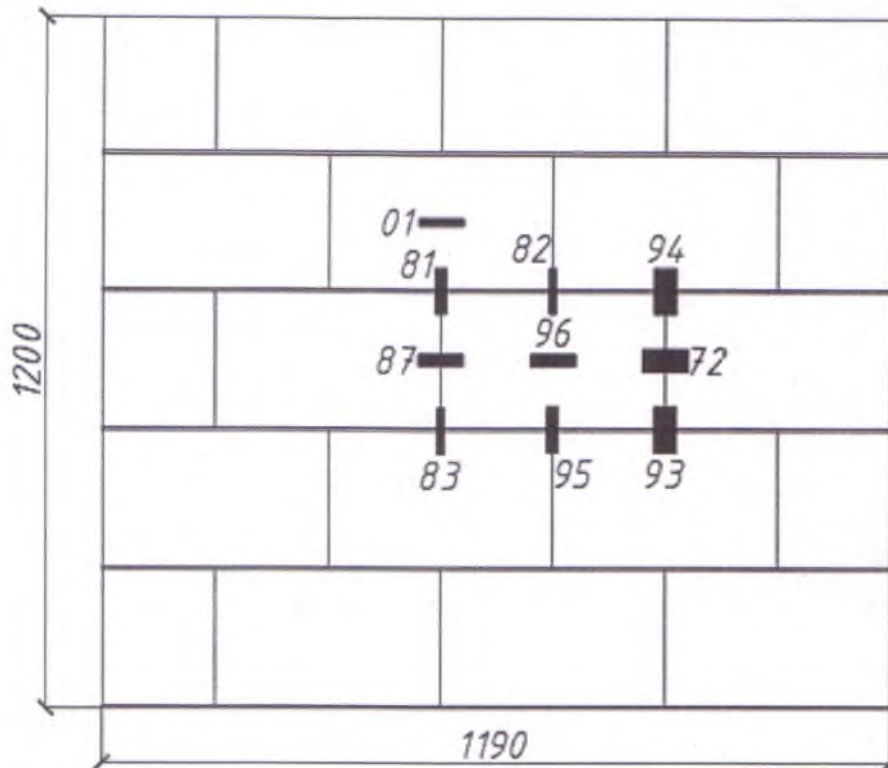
Схема размещения тепломеров на внутренней поверхности кладки фрагмента стены по варианту 1
